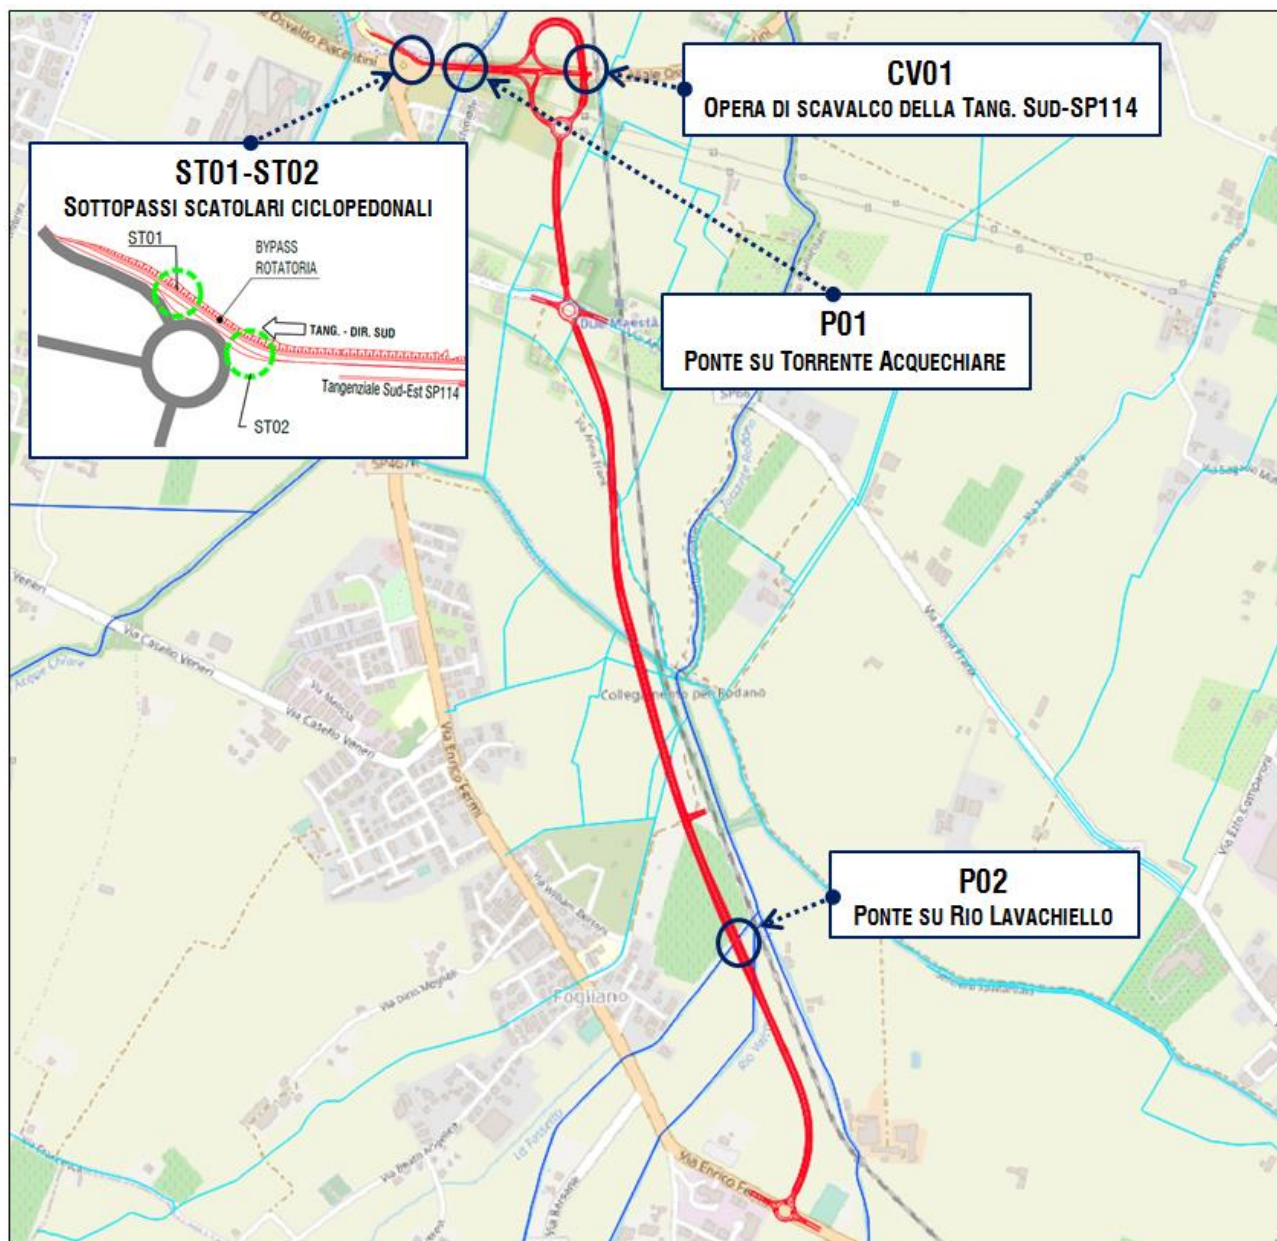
Planimetria generale: inquadramento delle opere maggiori.
